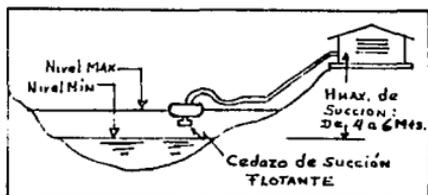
Sección transversal del conjunto Río-Estación de Bombeo.
